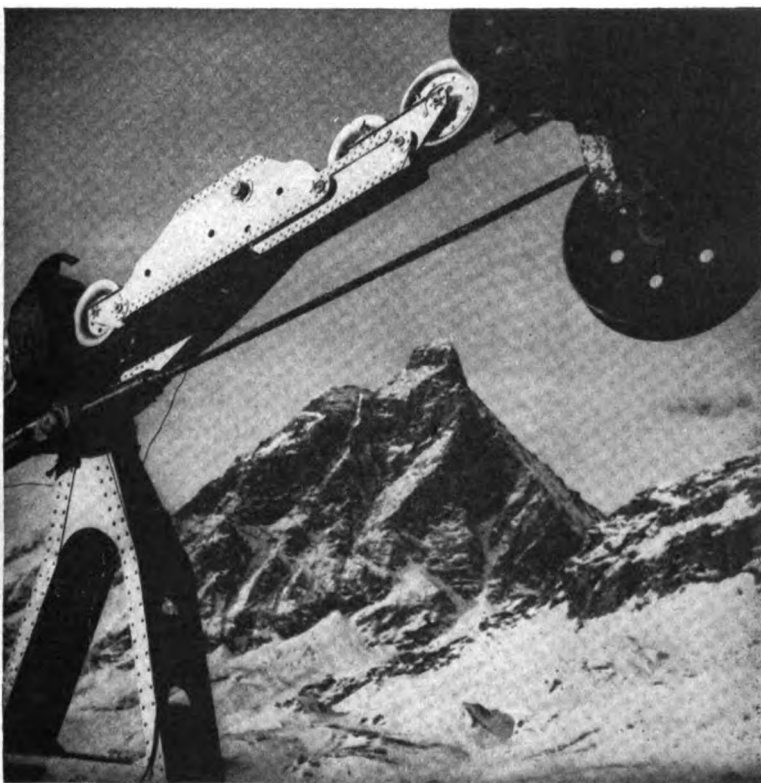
Carrello all'uscita dalla scarpa di un cavalletto e parte della sospensione con vista del Cervino.
